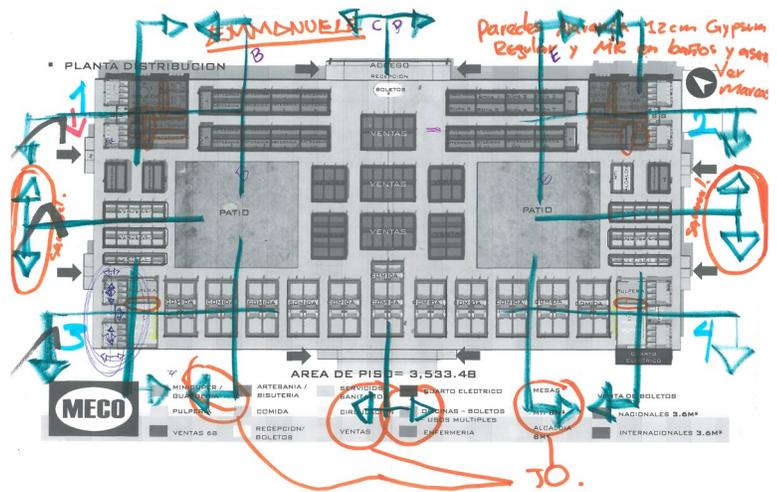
Plano: Planta Arquitectónica Tiangué.
